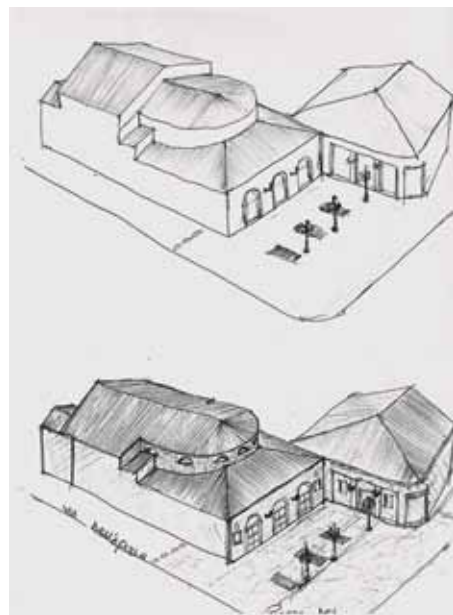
Progetto preliminare. Assonometria innalzamento torre scenica
